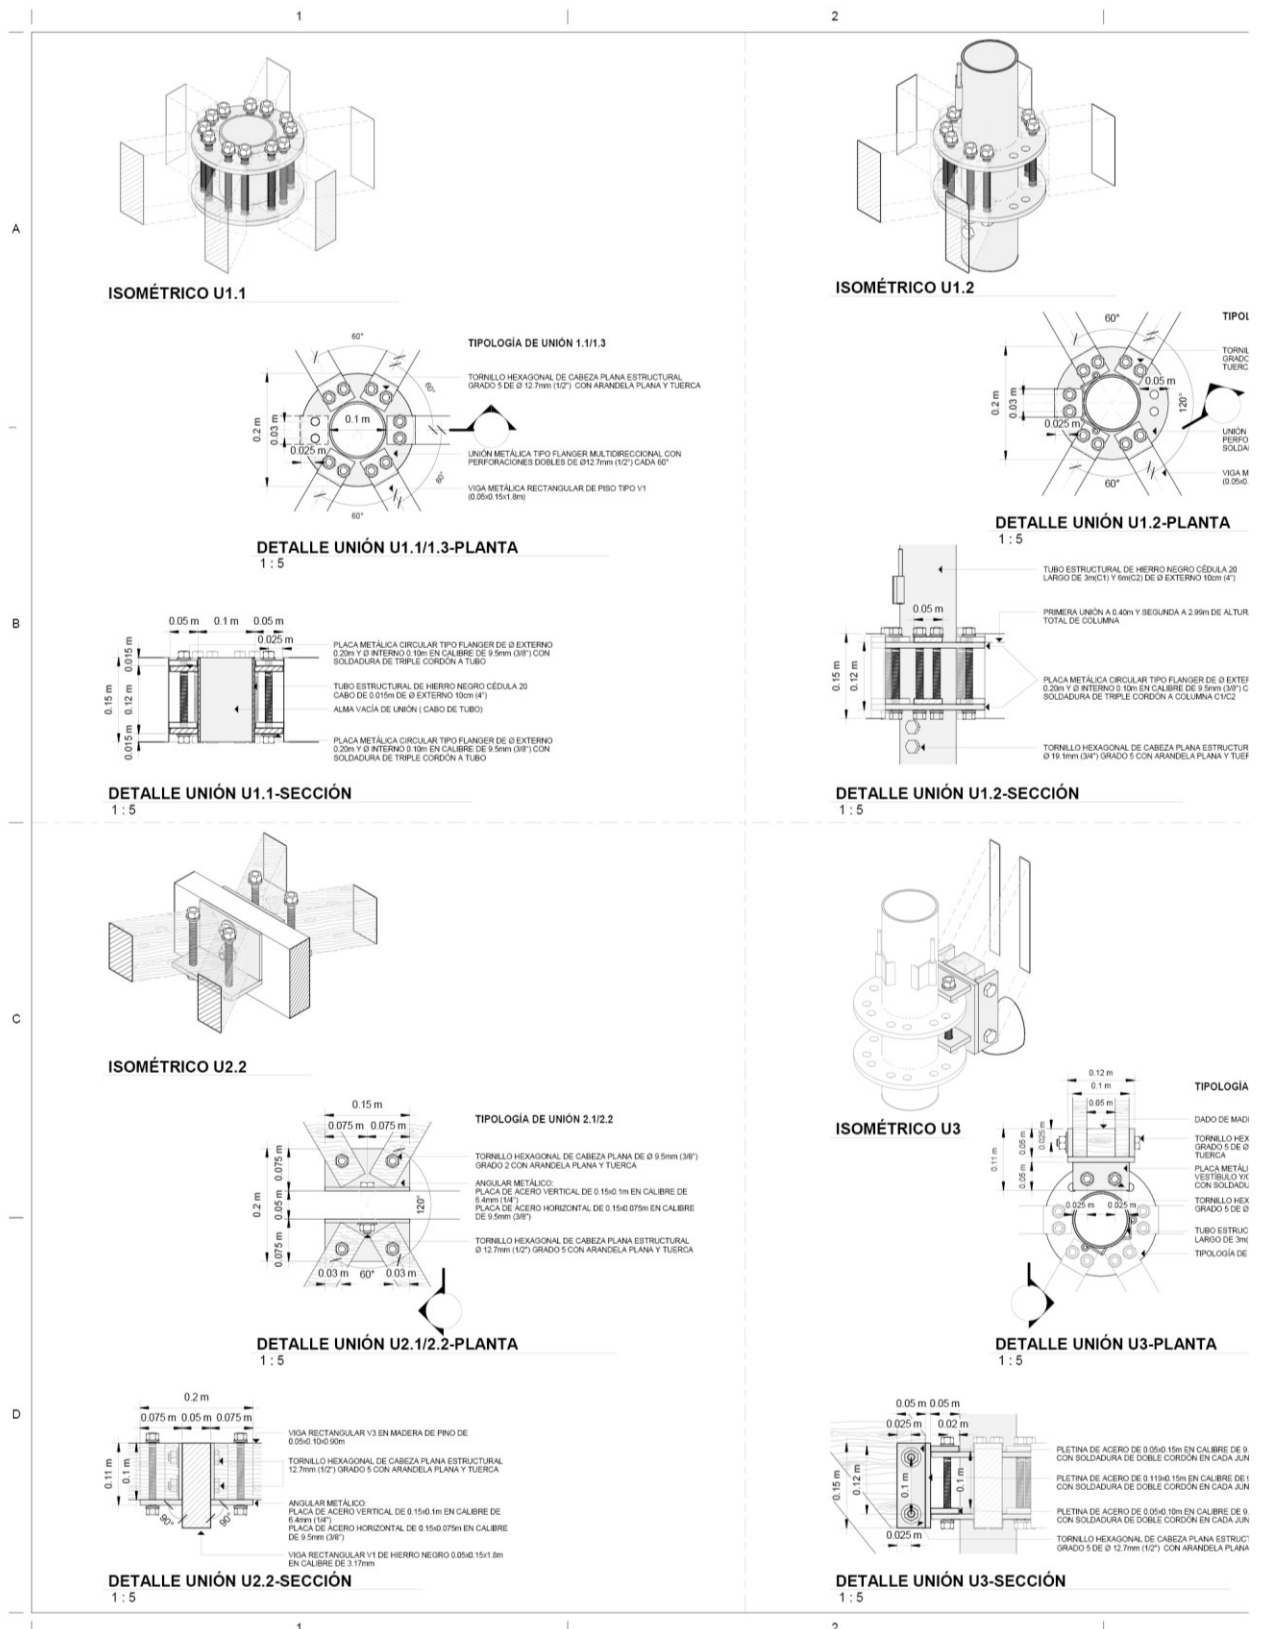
Lámina 16, planimetría de tipología B.<sup>325</sup>
